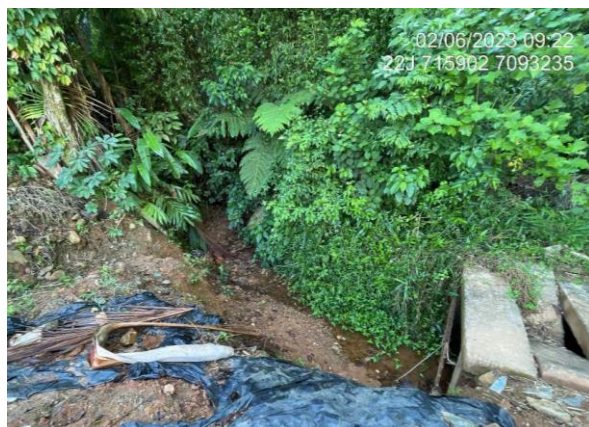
Trecho 22, vista para montante, a partir da rua Avaí. Fonte: Autores.
